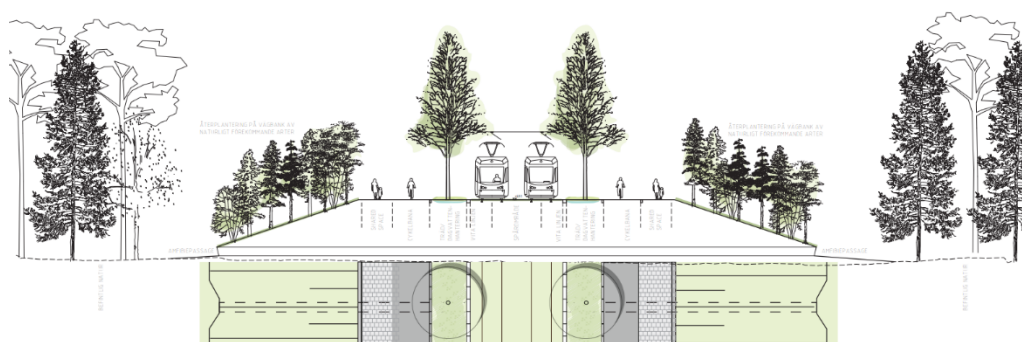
Sektion med planillustration av möjlig utformning av marknära brokonstruktion. Gatan och kollektivtrafiken går på en bank med ett underliggande tunnelsystem för amfibier. Bild: White arkitekter.
